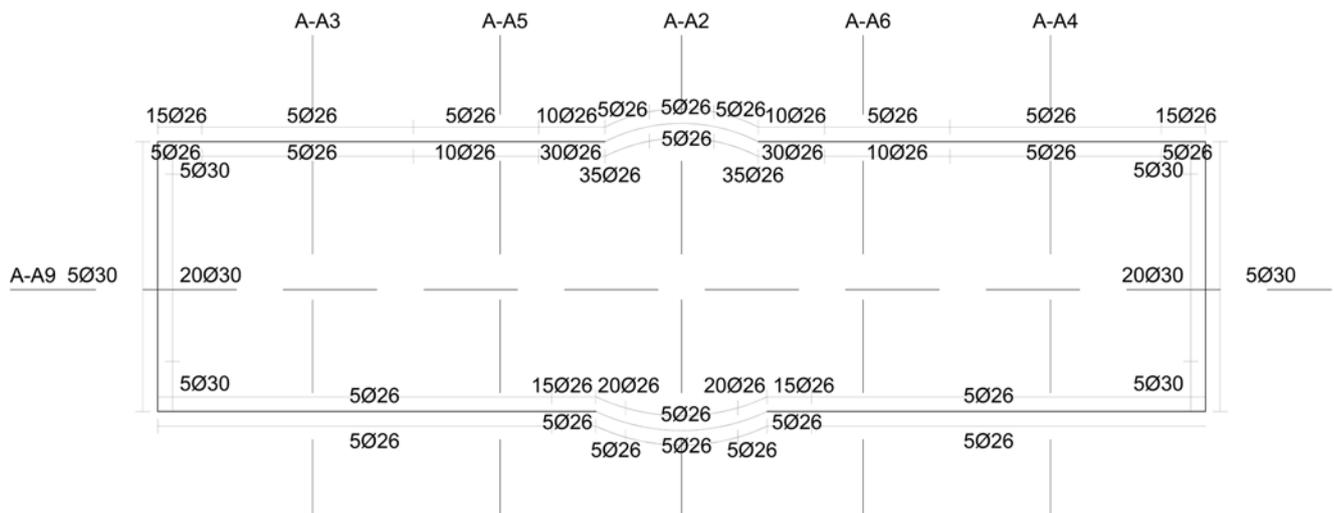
Sezione A-A1 – Armatura in direzione Y
